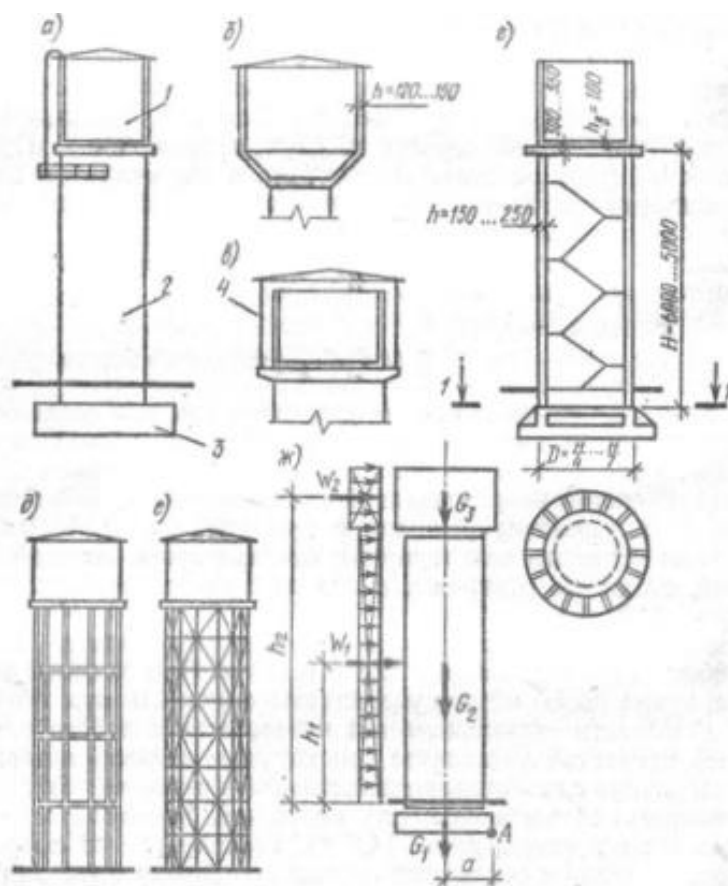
Конструкции (а...е) и схема расчета на опрокидывание (ж) водонапорных башен: диванив 1 — резервуар; 2 - опора; 3 — фундамент; 4 - шатер 322
